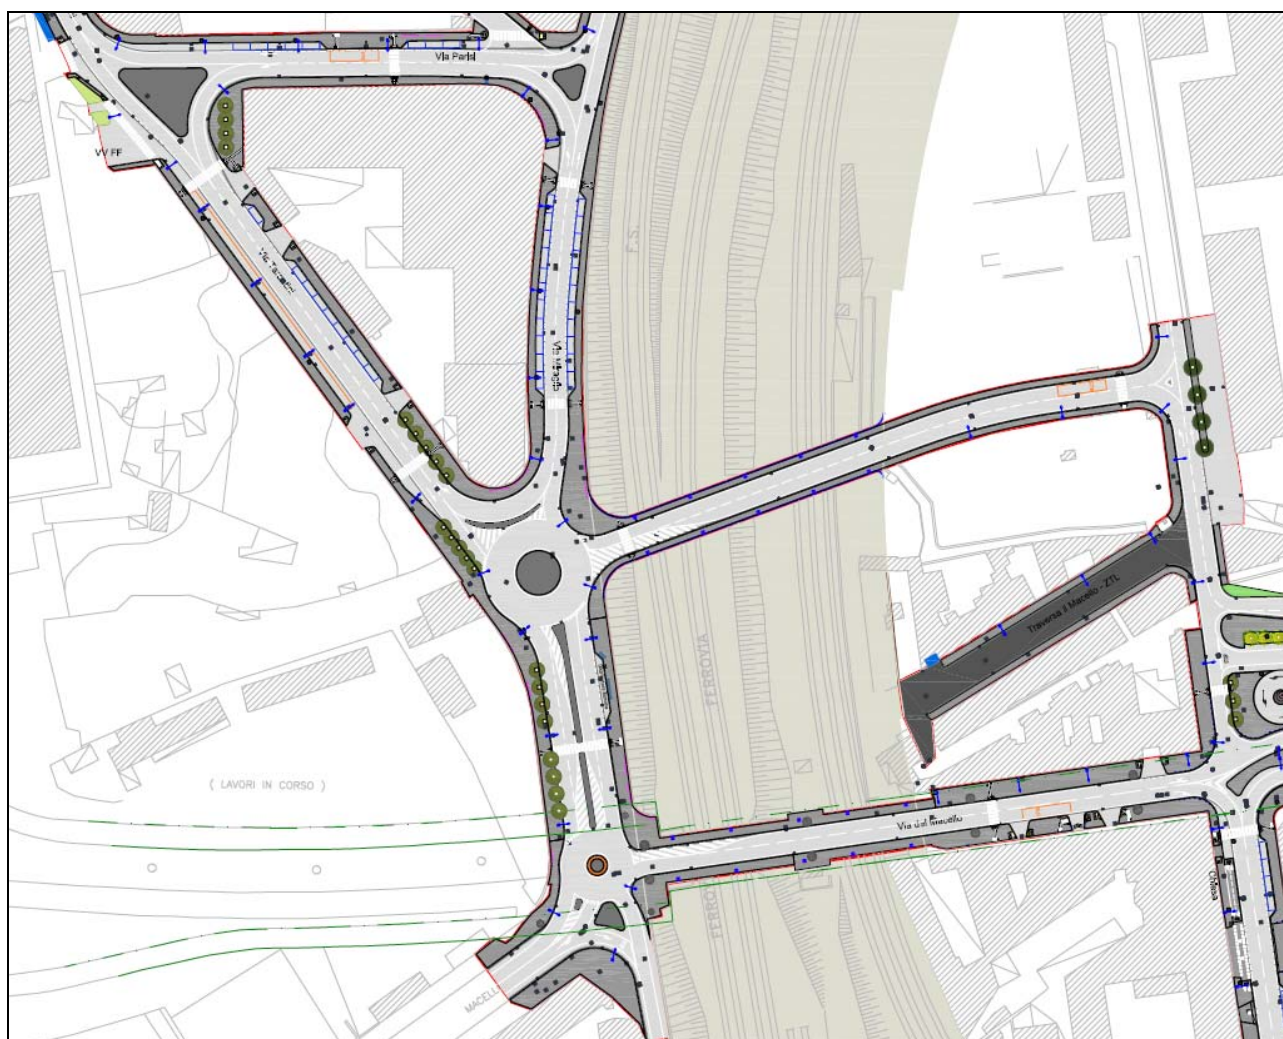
Individuazione planimetrica nuovo asse viario di collegamento tra via Traccia Poggioreale e via Miraglia con attraversamento ferroviario di progetto
